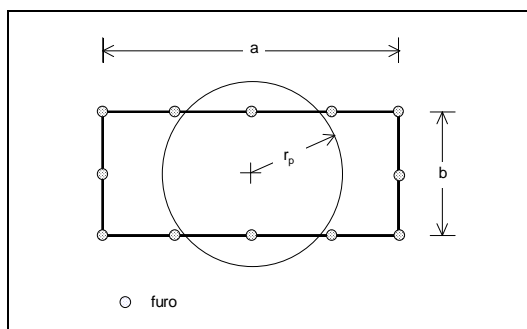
Raio do poço equivalente (adaptado de DRISCOLL, 1986).
